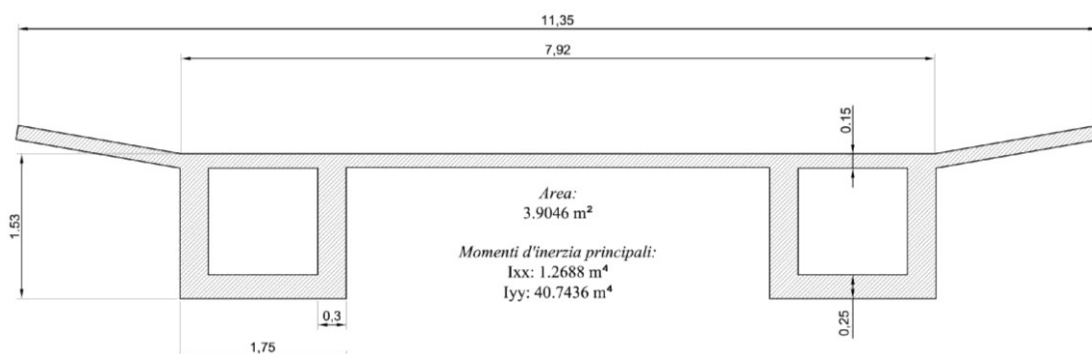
Sezione trasversale ponte sul nuovo canal salso pre-retrofitting [64]
